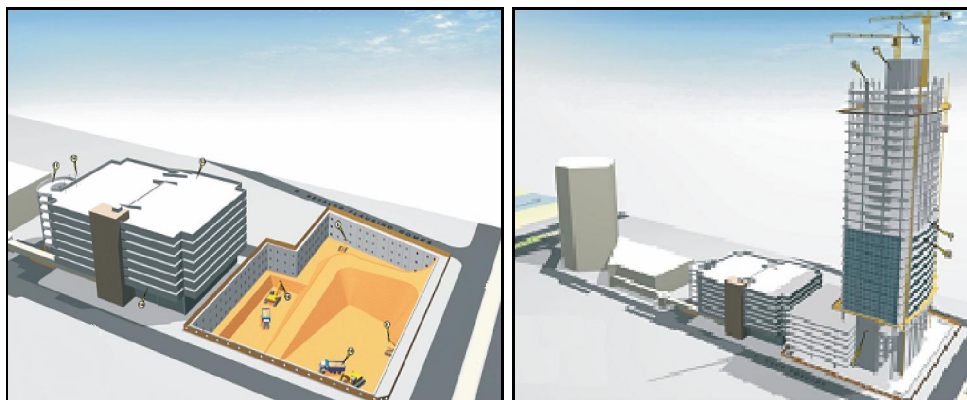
e 02 – Esquema do canteiro de obras: etapa de escavação e finalização da fase estrutural
